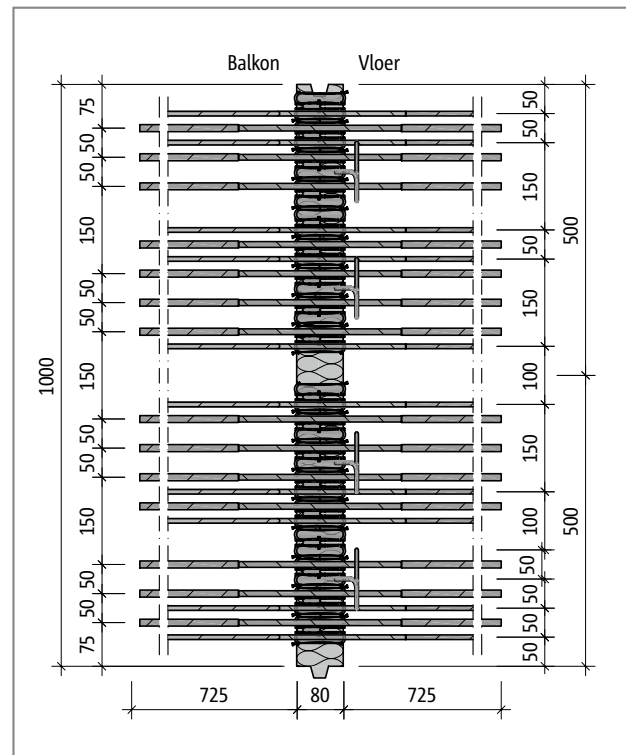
Schöck Isokorb® T type K-E-M6, K-T-M7, -M9, -M10: Zijaanzicht
